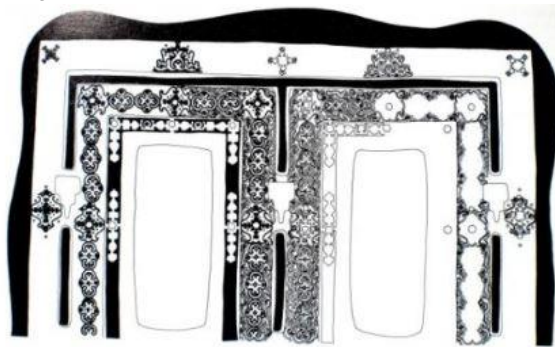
Decoración tipo de puertas en ciudades caravaneras
